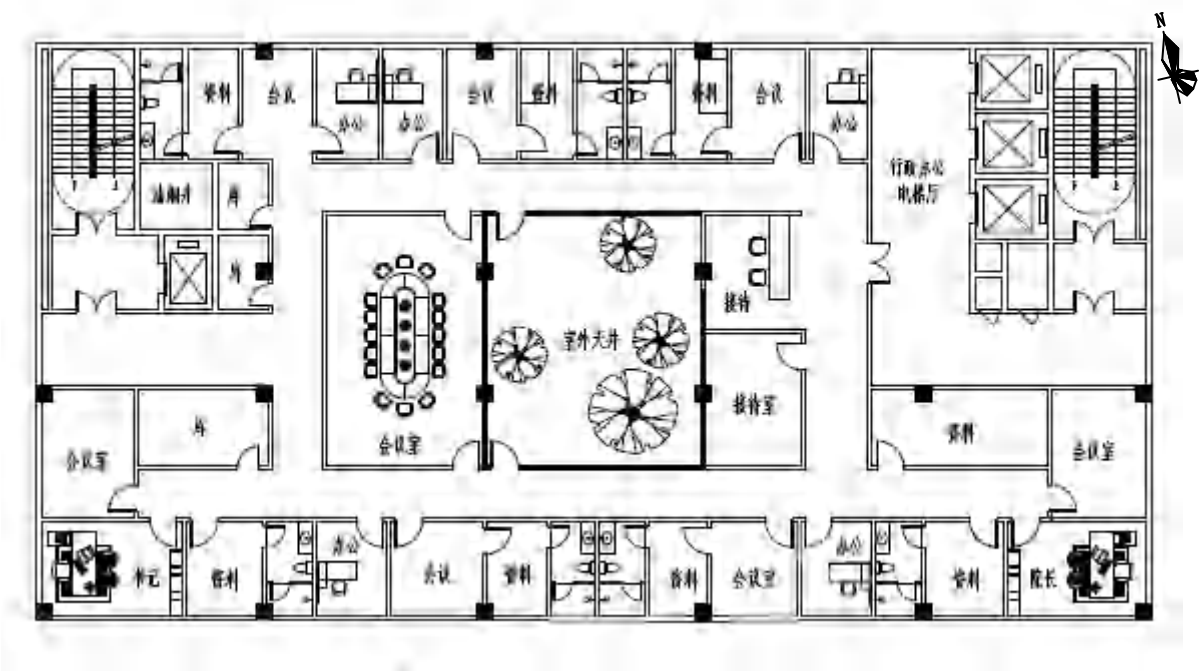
项目医疗综合楼裙楼—行政科研楼十一层平面布置图（比例尺：1:297）
